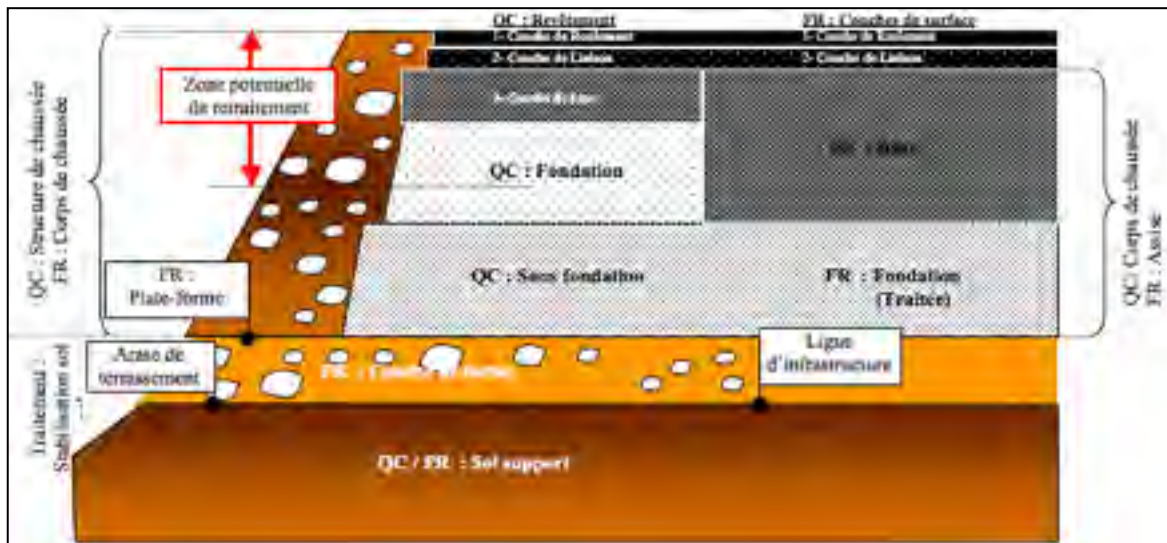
Illustration de la structure d'une chaussée bitumineuse
